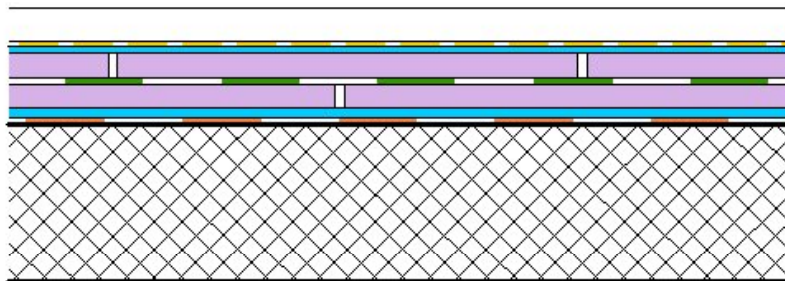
Ausführung der Dachterrasse mit 5 cm Vakuum-Dämmplatten.
